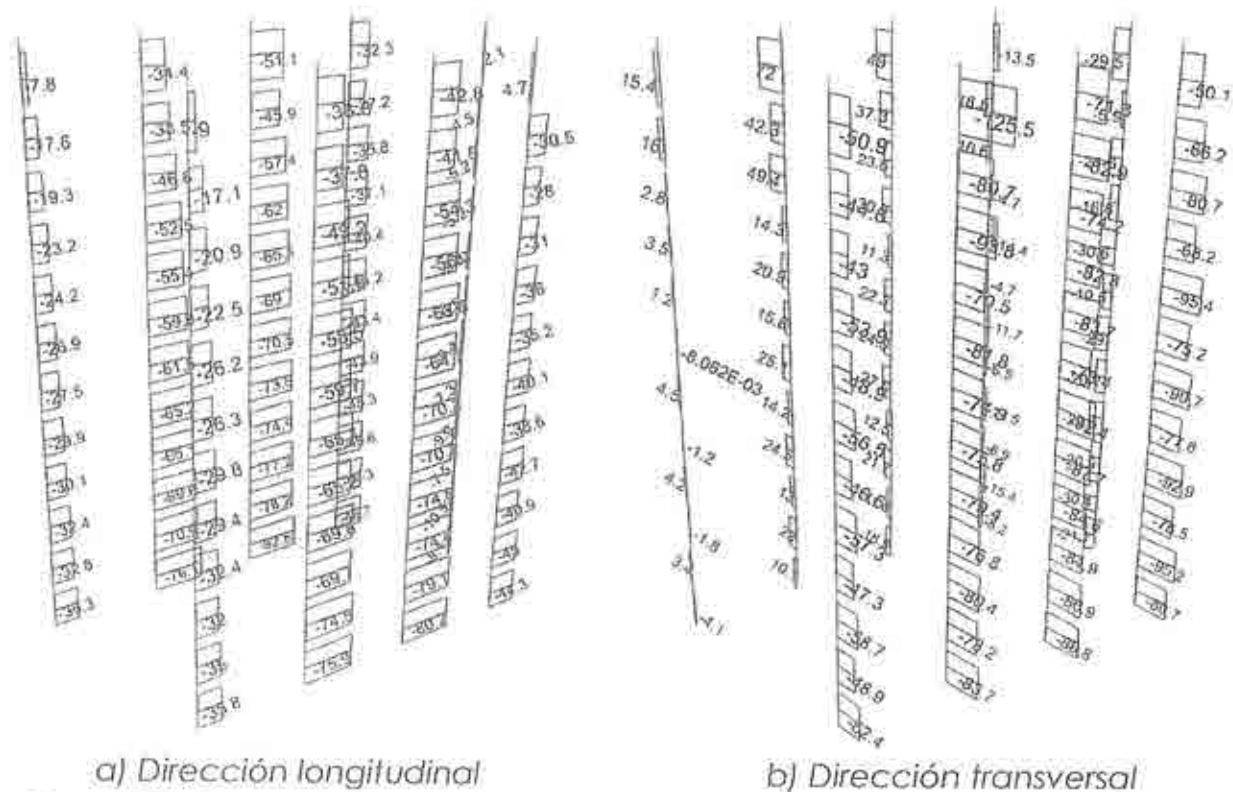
Diagramas de fuerza cortante en columnas. Oficina 6 a Azotea.
